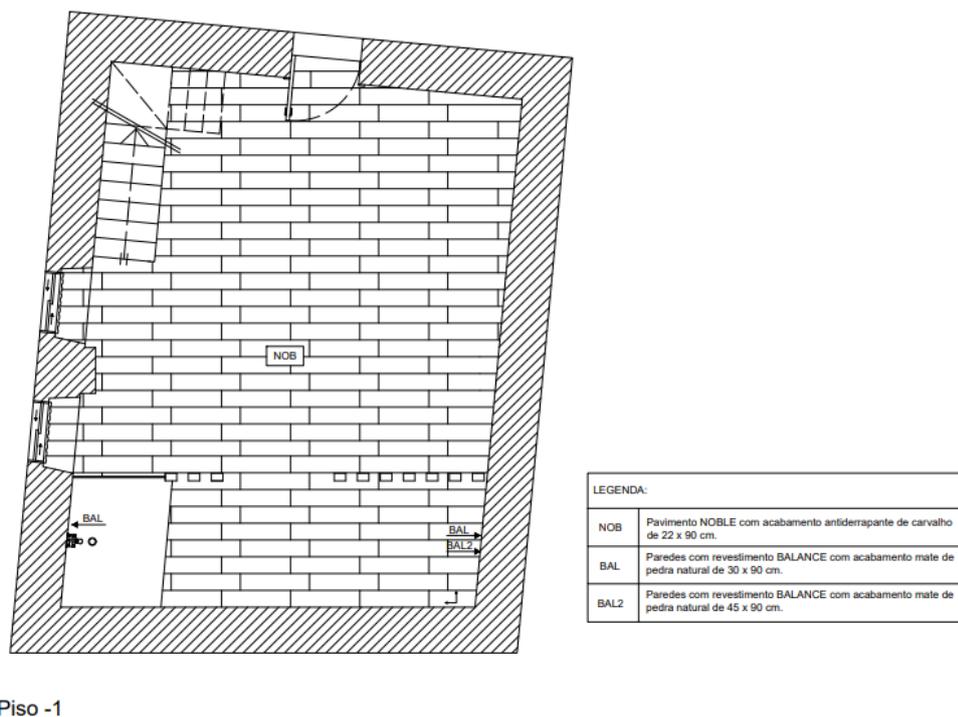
Planta de pavimento piso -1. Fonte: Maria Leonor.
